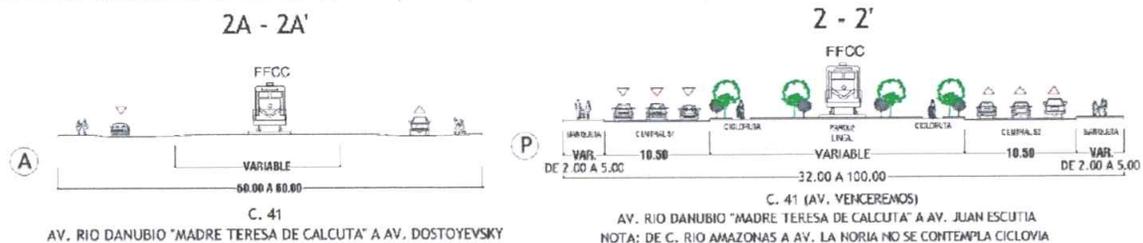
Sección vial futura C. Venceremos. Fuente PDU 2040 vigente.
